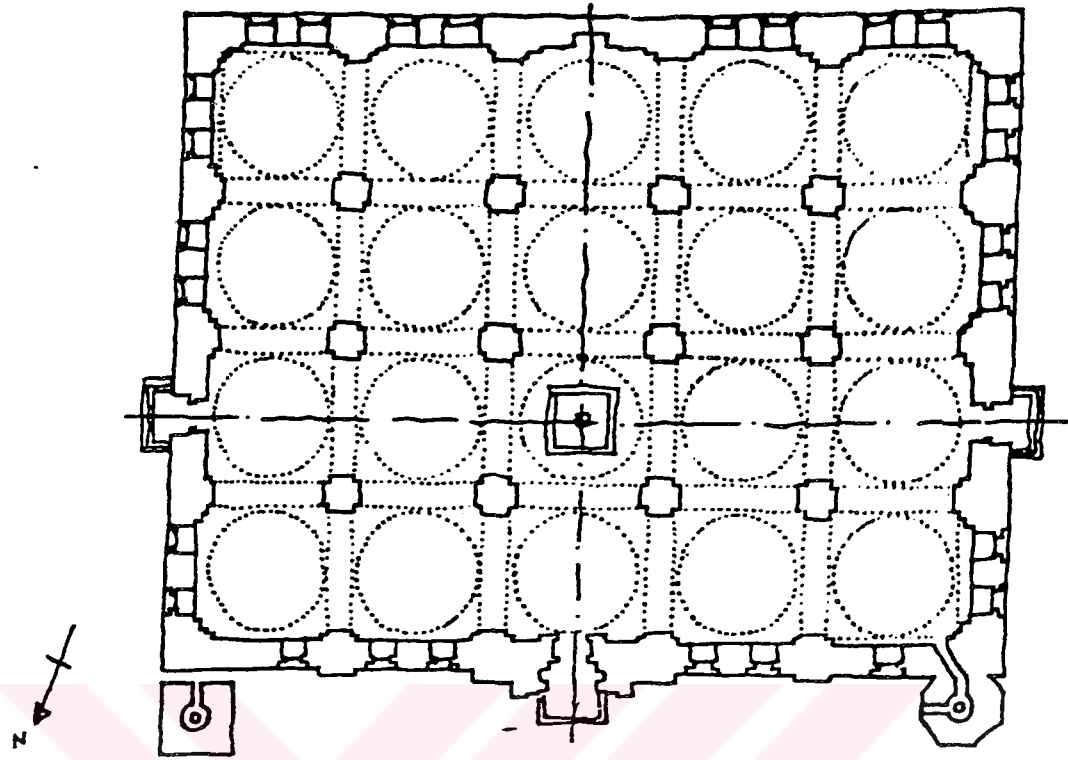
İbni Neccar Camii, Kastamonu. Plan (A.S. Ülgen'den)
